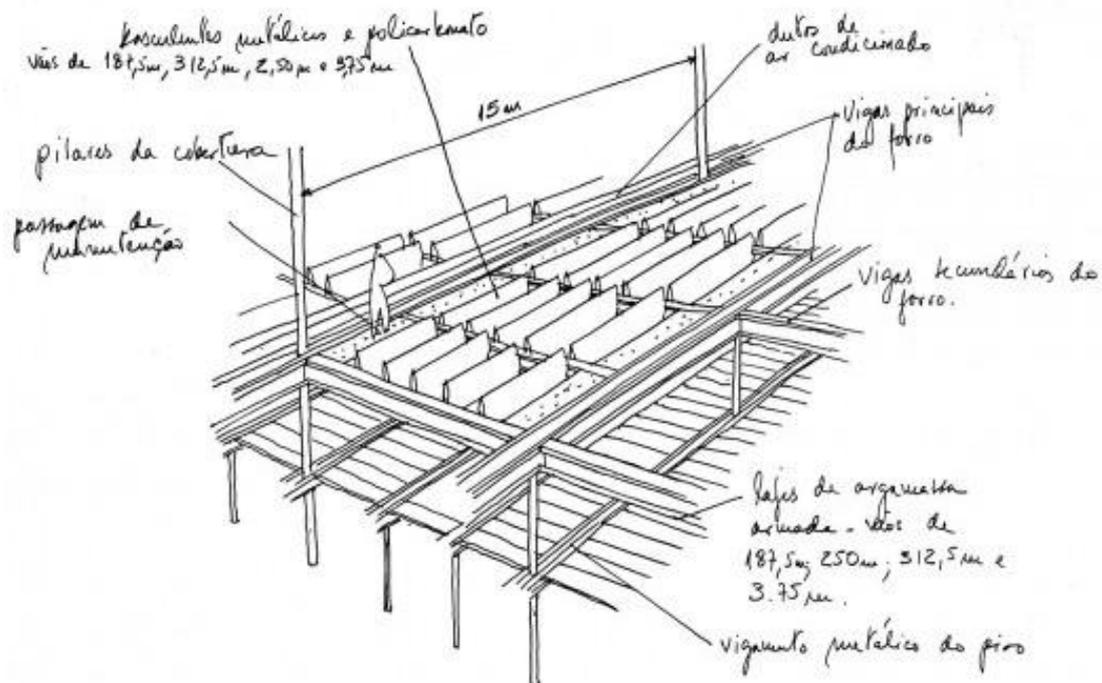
Esquema de los componentes del piso técnico y techo de la primera planta
